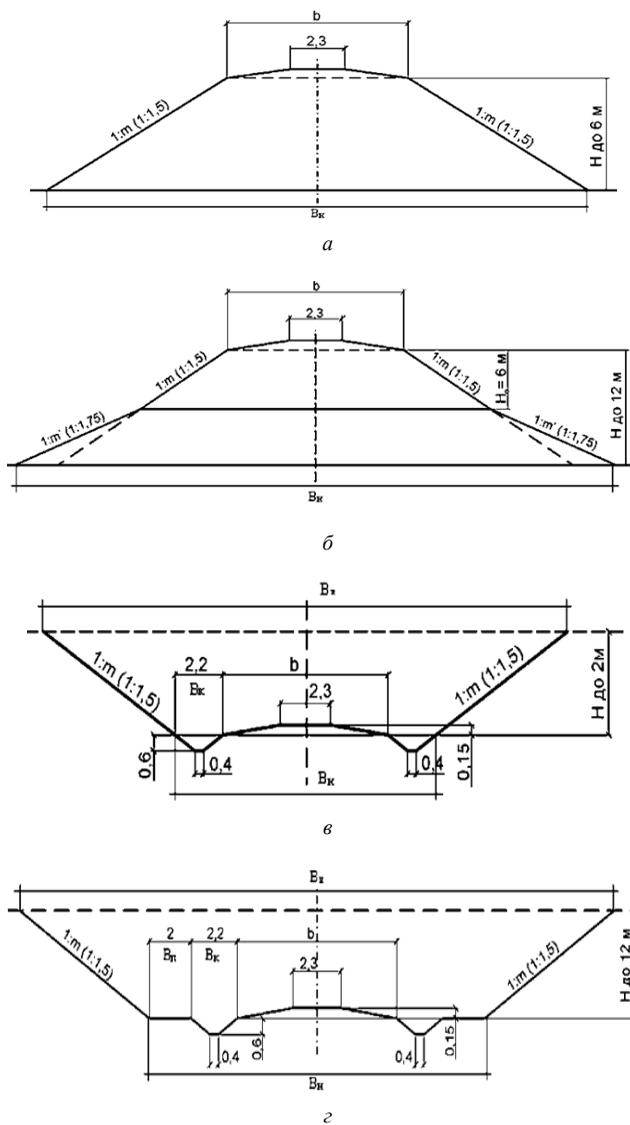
Типы поперечных профилей земляного полотна: а – насыпи высотой до 6 м из недренлирующих грунтов; б – насыпи высотой более 6 м; в – выемки глубиной до 2 м в недренлирующих грунтах; г – выемки глубиной до 12 м в недренлирующих грунтах
